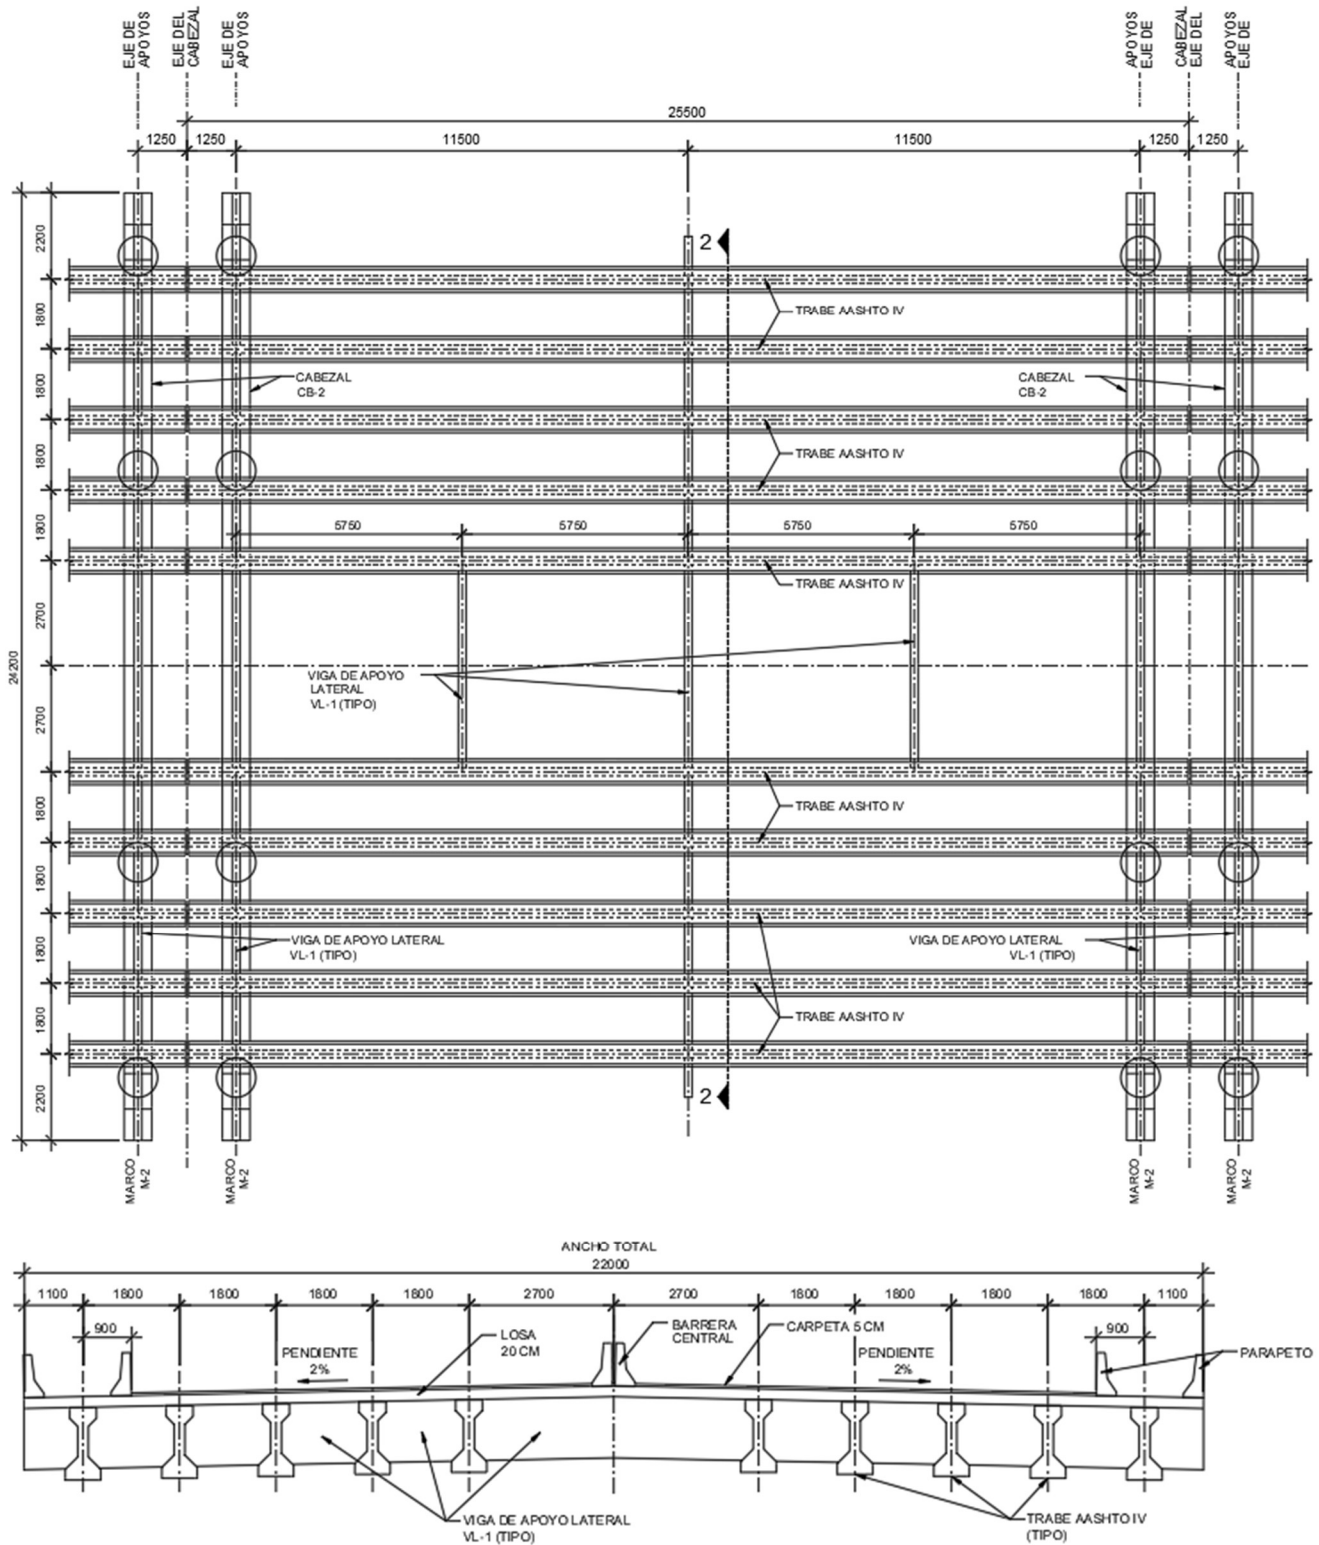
Vista en planta y elevación del cabezal CB-2, para marcos M-2 y M-4
